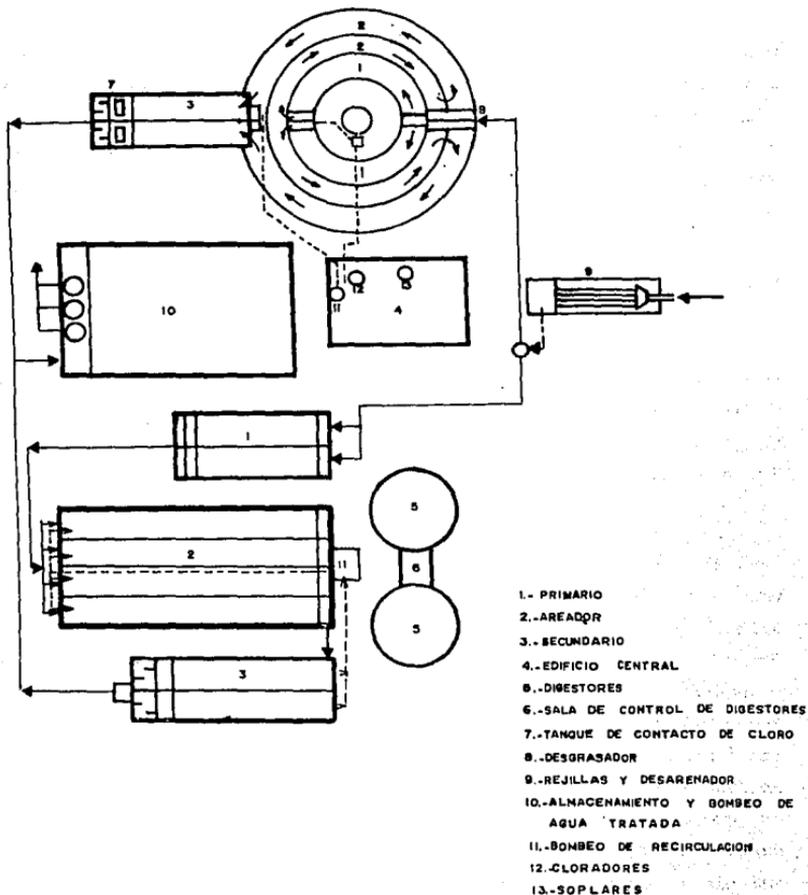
PLANTA DE TRATAMIENTO SAN JUAN DE ARAGON
